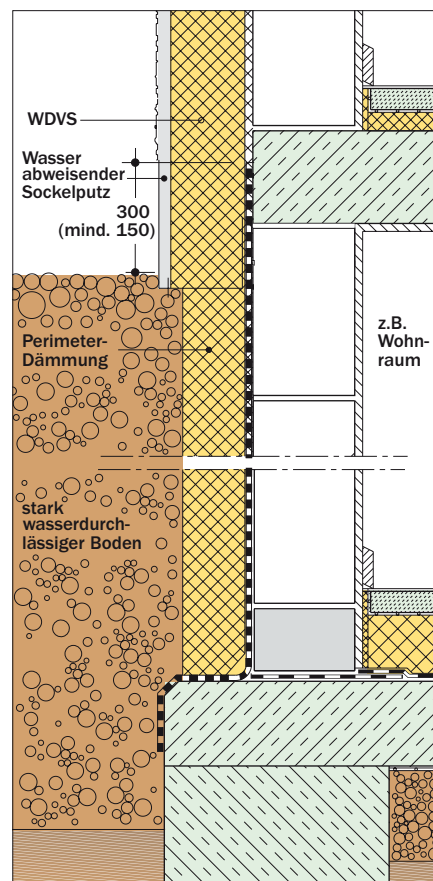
Unterkellertes Gebäude mit Wohnraum im Untergeschoss; Wärmeschutz mit Perimeterdämmung; Abdichtung durch KMB
